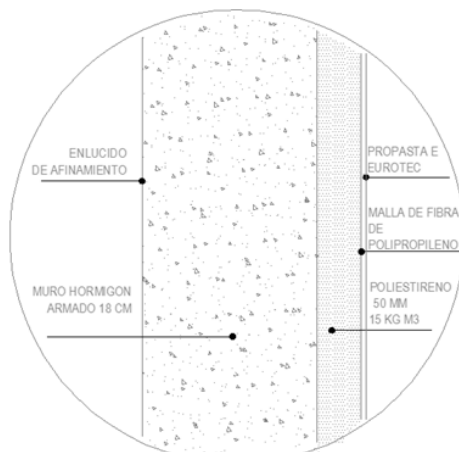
Detalle de un muro exterior del departamento (Madrid, 2010)
